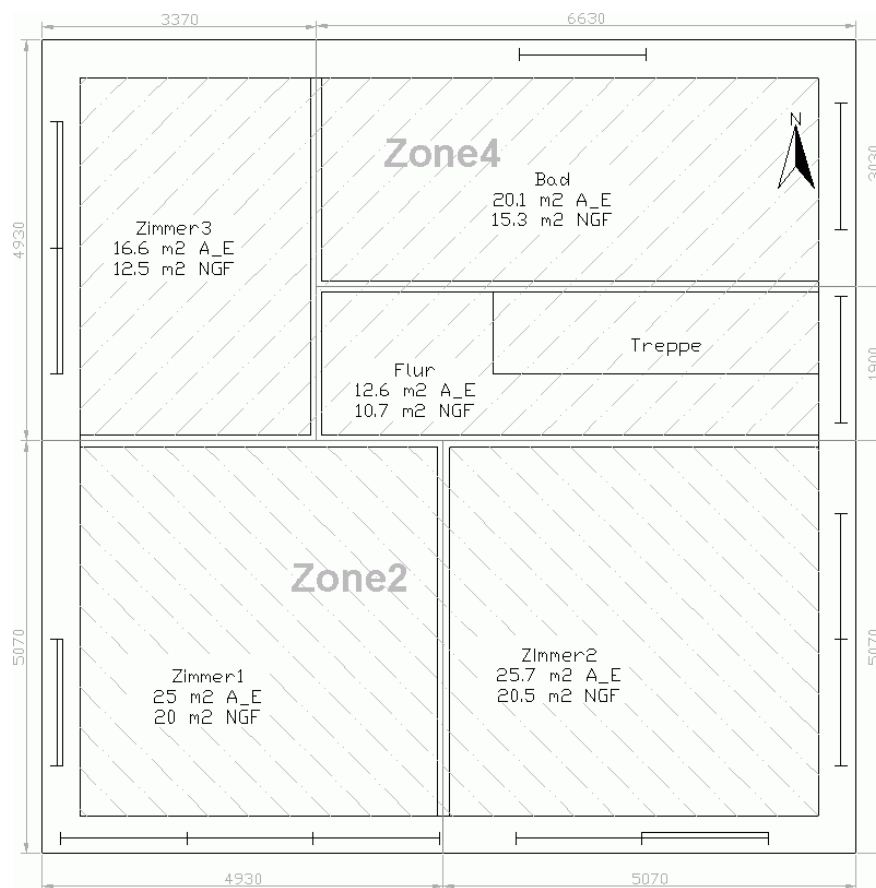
Grundriss des Minergie-P® Referenzgebäudes für das Obergeschoss
